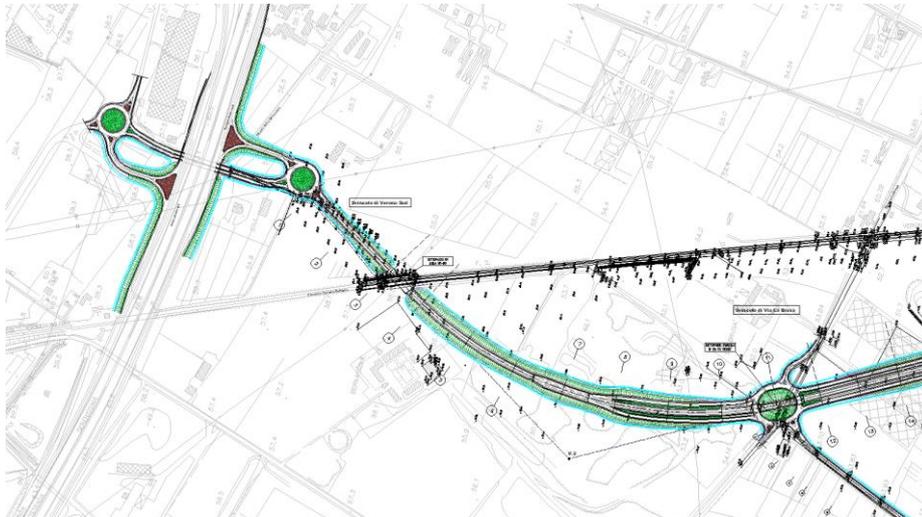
Tratto Svincolo di Verona Sud - Svincolo di Via Cà Brusà - Planimetria
